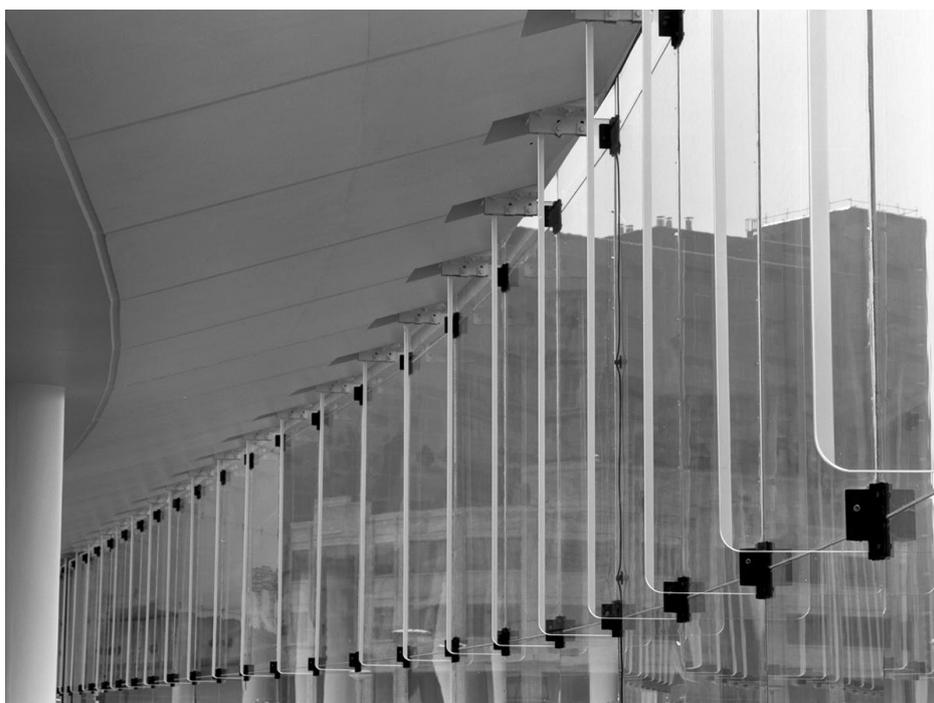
Muros cortina de vidrio estructural. (Fran Bretones,2014: 50).
